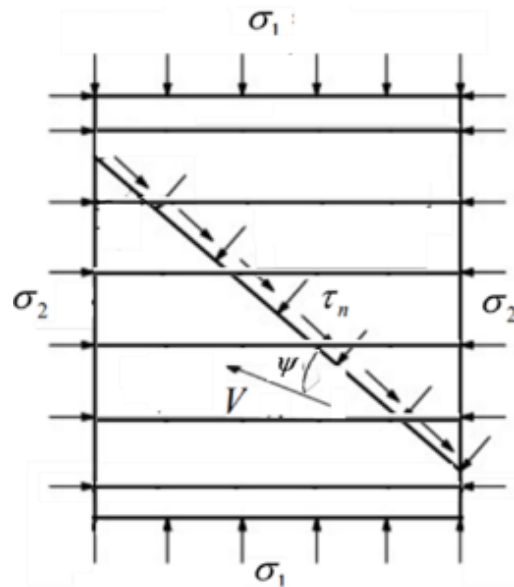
Кінематична схема руйнування залізобетонного елемента
